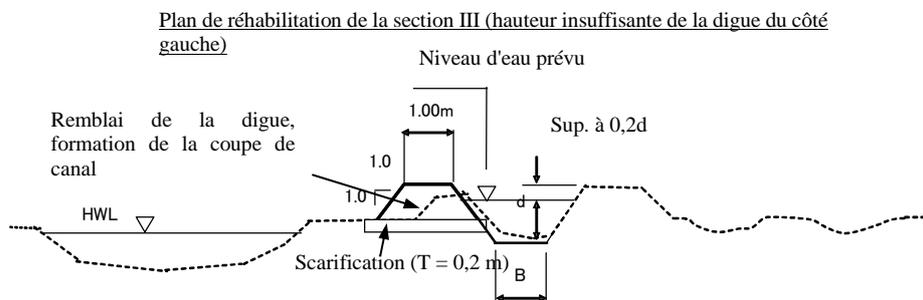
Plan de base de réhabilitation des canaux d'irrigation secondaires (section III)
